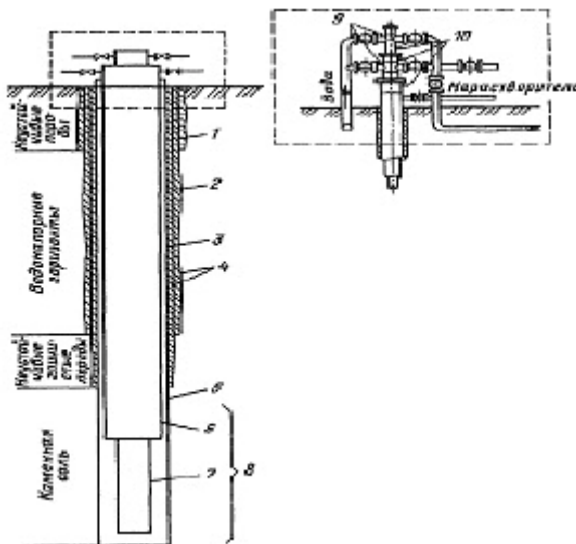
Конструкція свердловини, підготовленої до спорудження безшахтного резервуара: 1 – напірник; 2 – кондуктор; 3 – основна обсадна колона; 4 – цементний камінь; 5 – необсаджена частина свердловини; 6, 7 – відповідно зовнішня і центральна підвісні колони; 8 – інтервал залягання підземного резервуара; 9 – термоізоляція; 10 – пробовідвідні крани
